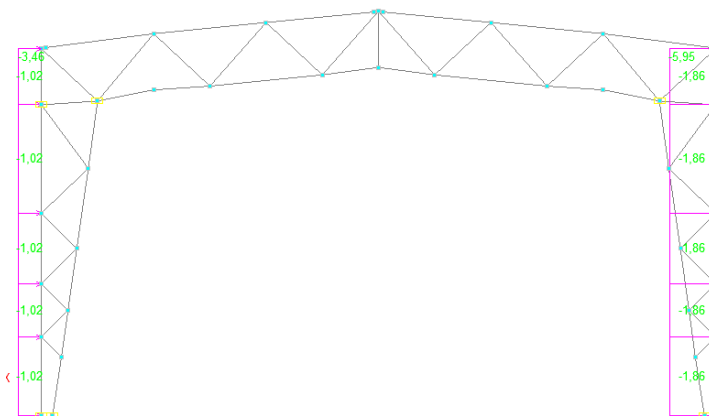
Схема загрузки ветровой нагрузкой
